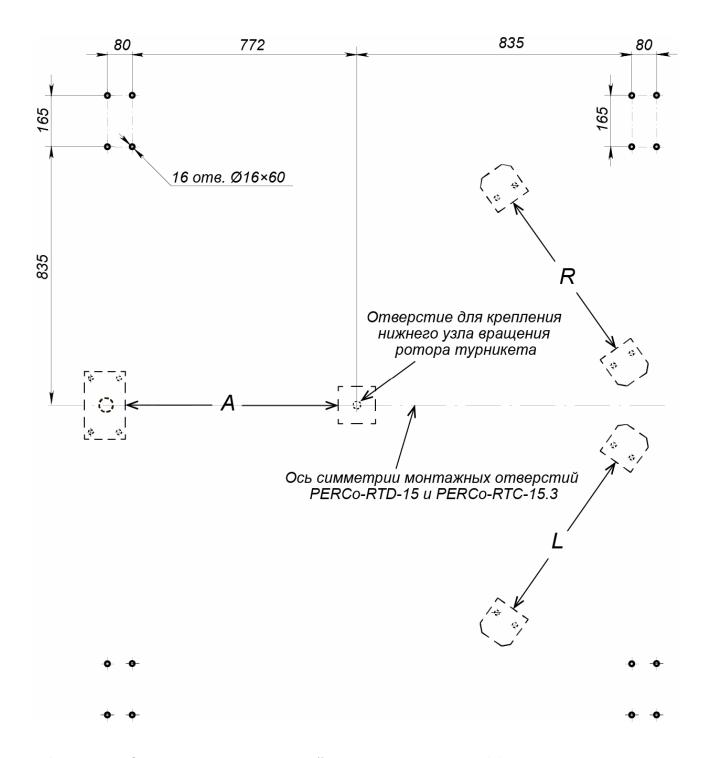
Схема разметки отверстий для крепления стоек (3) крыши относительно отверстий для крепления турникета:
